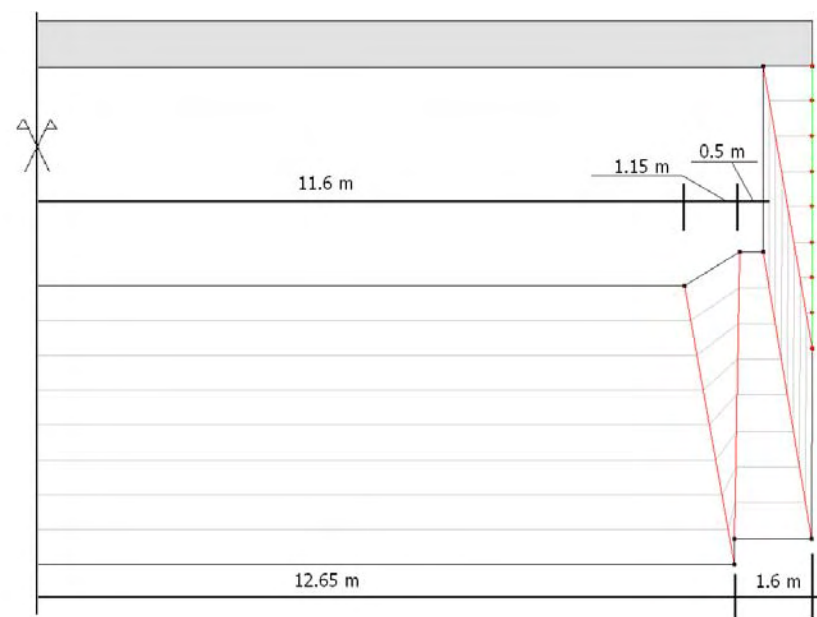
Ensanchamiento de la sección y de las zapatas de los muros en los primeros 4 m aguas abajo del puente de la C/ Paraguay. Vista desde aguas abajo
